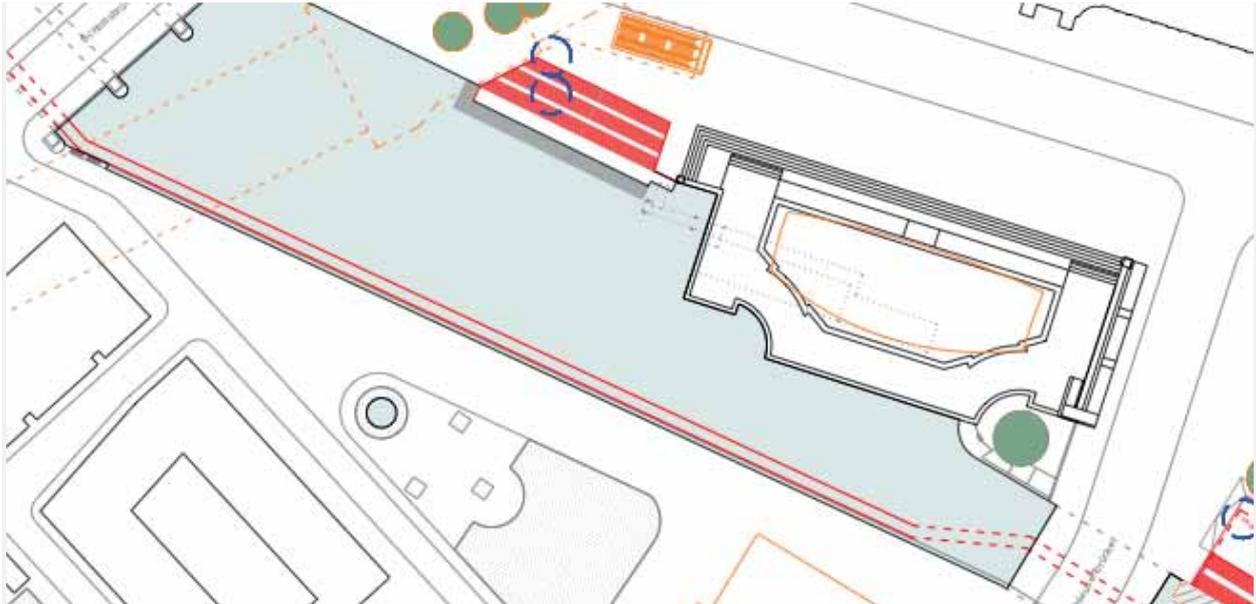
Schwimmbereich Grundriss Wasserzugang Schlossfreiheit (LP_Gesamt-Massn_1000.pdf)
